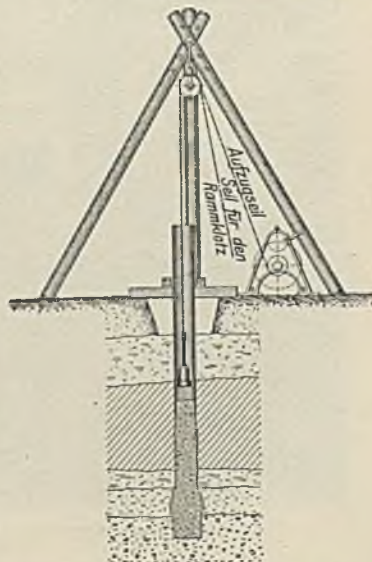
Herstellungsweise der Betonpfähle Bauart Strauß.
